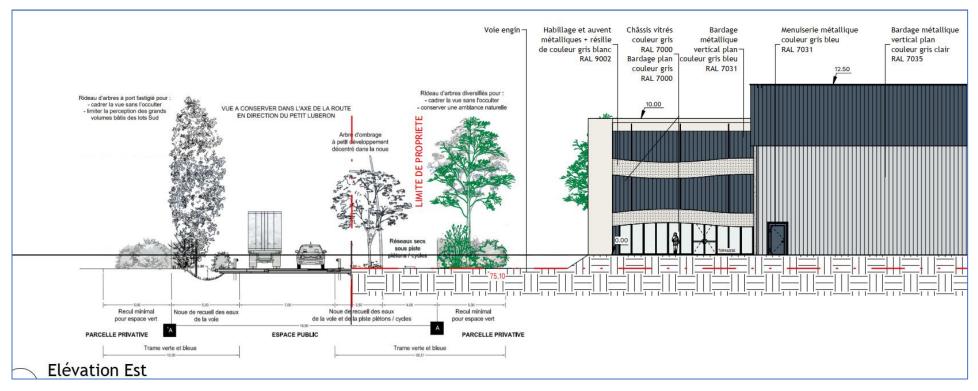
Plan de coupe du projet (y compris voie d'accès à la zone)
